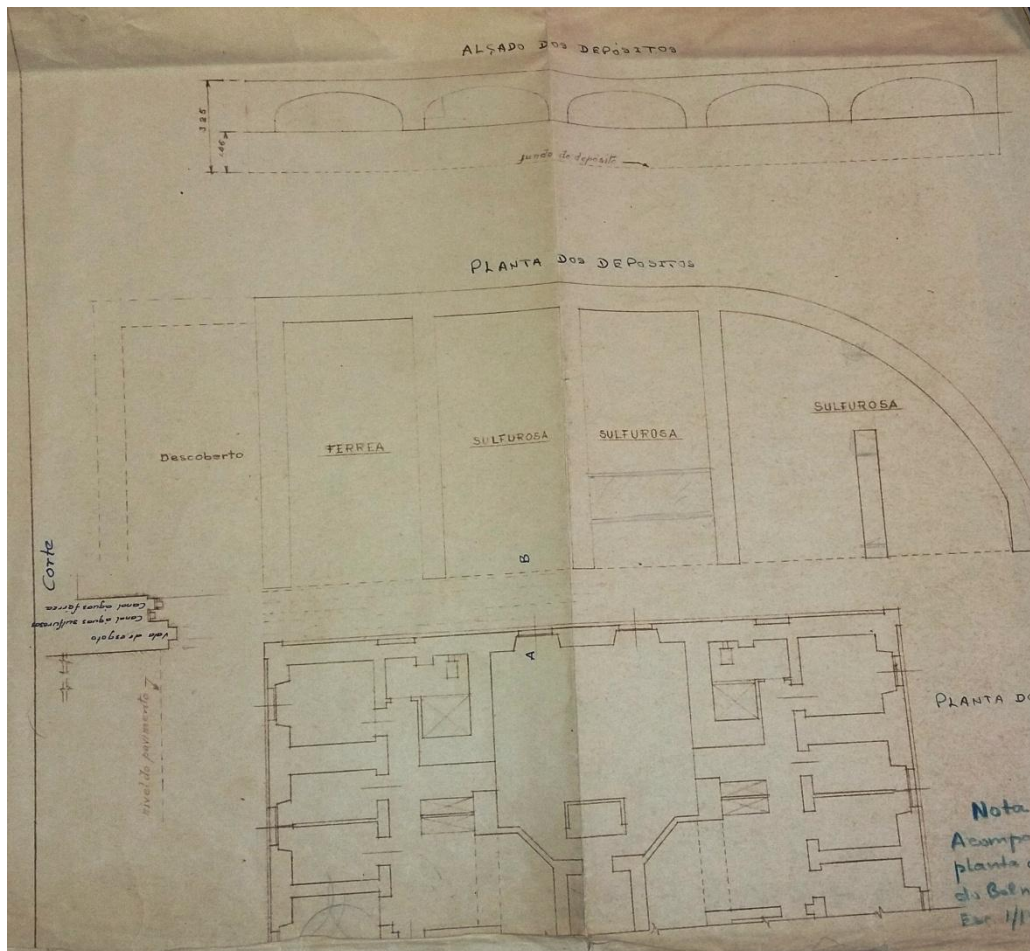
Planta e alçado dos tanques de arrefecimento
